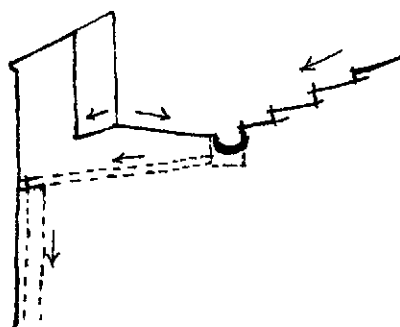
Convento do Carmo de Vidigueira. Platibanda da cobertura da nave da igreja. Corte esquemático de pormenor referente ao escoamento das águas pluviais
